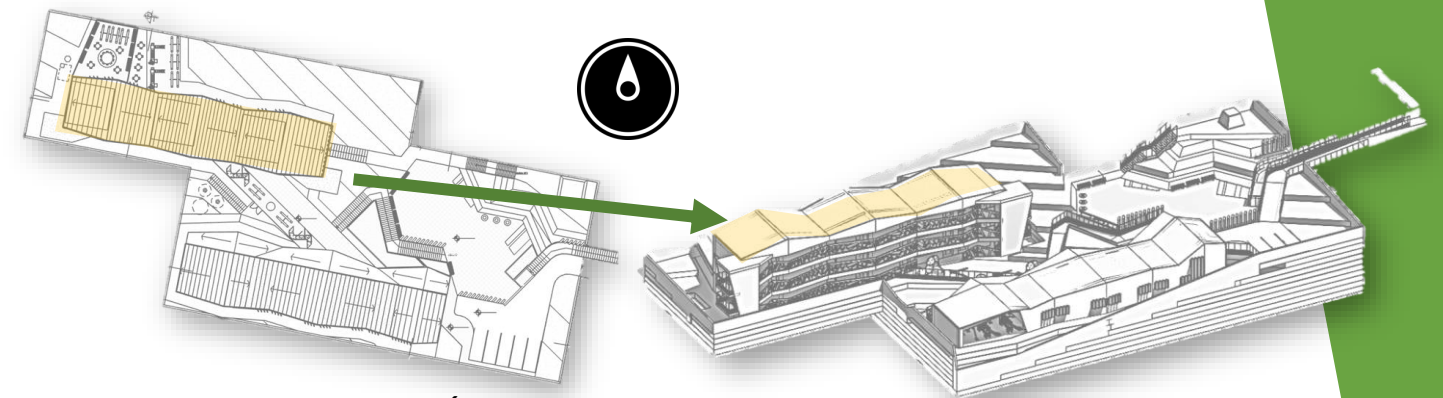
CUBIERTAS MÁS EXPUESTAS AL SOLEAMIENTO
